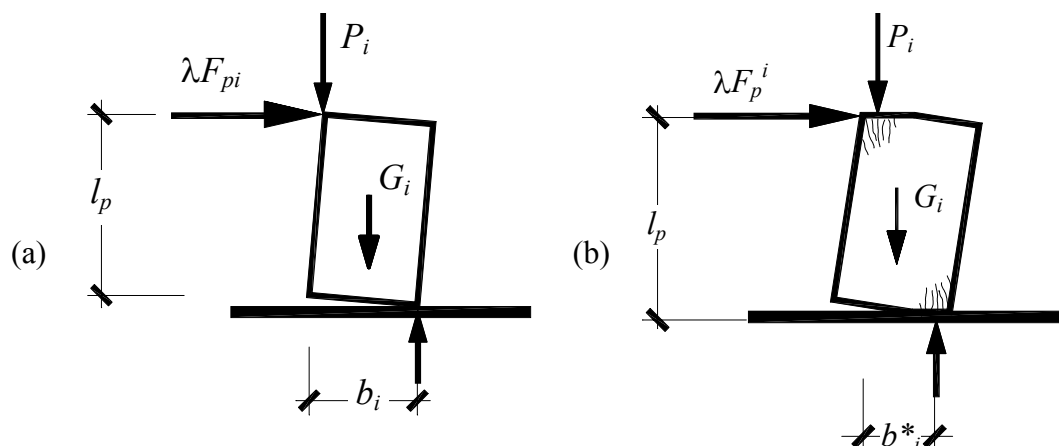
Equilibrio limite di un singolo maschio murario: a) muratura rigida ed infinitamente resistente; b) muratura deformabile a rottura per compressione nello spigolo di base.
